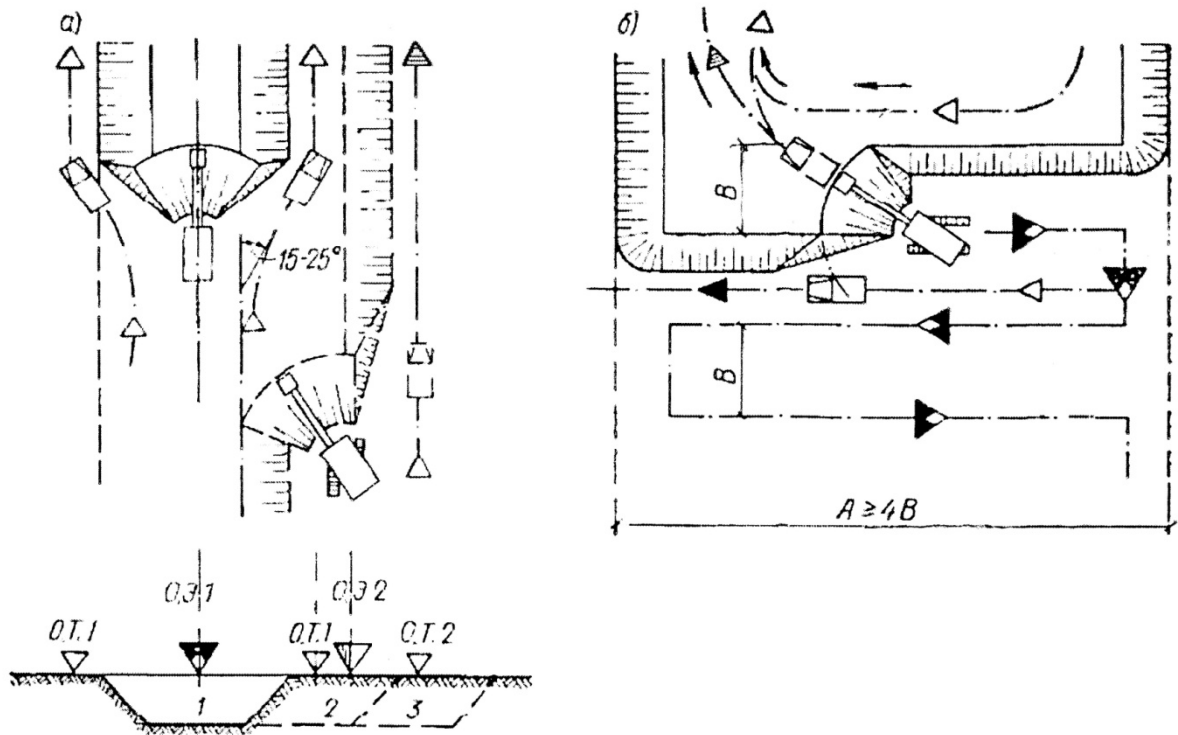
Схемы проходок экскаватора с «обратной лопатой» или драглайна:
